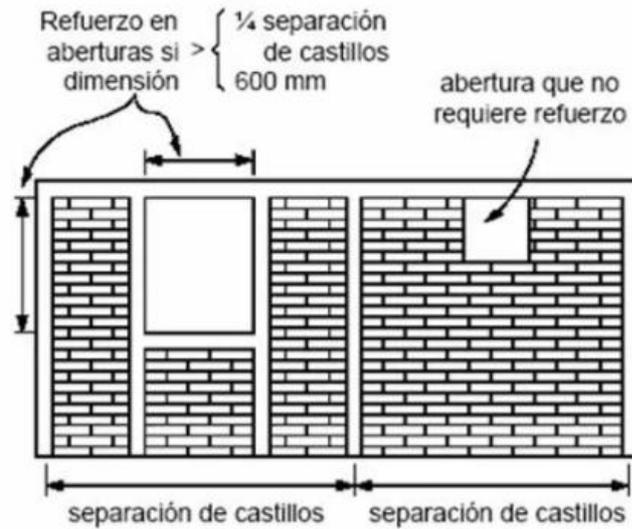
Vista de muro trabado con bloques de hormigón unidos por mortero de pega.
